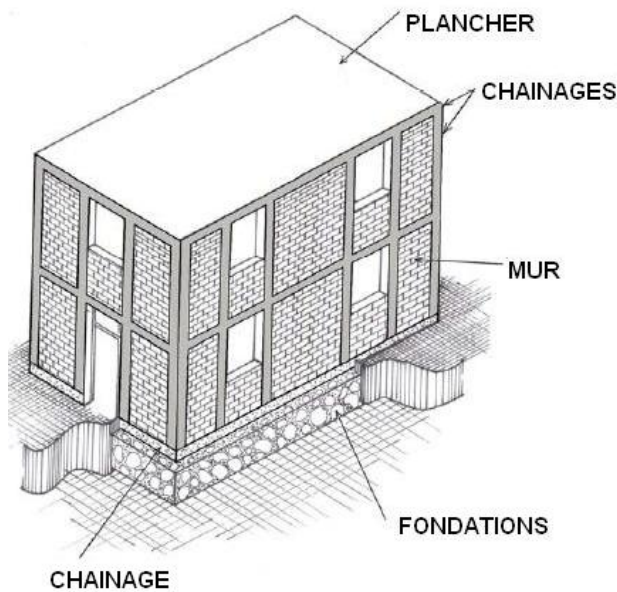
Construction en maçonnerie chaînée avec plancher en béton armé
